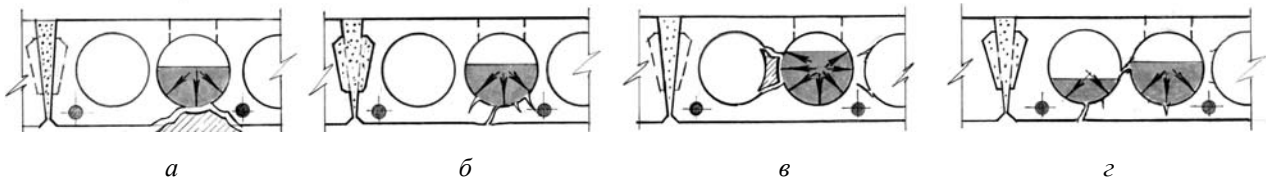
Схеми руйнування бетону плит: а – відколювання бетону на ділянках 0,4–1,5 м біля опор; б – тріщини вздовж другої від краю порожнини по нижній грані окремими ділянками завдовжки 0,8–5,0 м; в – імовірна схема руйнування поздовжнього неармованого ребра; г – тріщина вздовж крайньої порожнини
